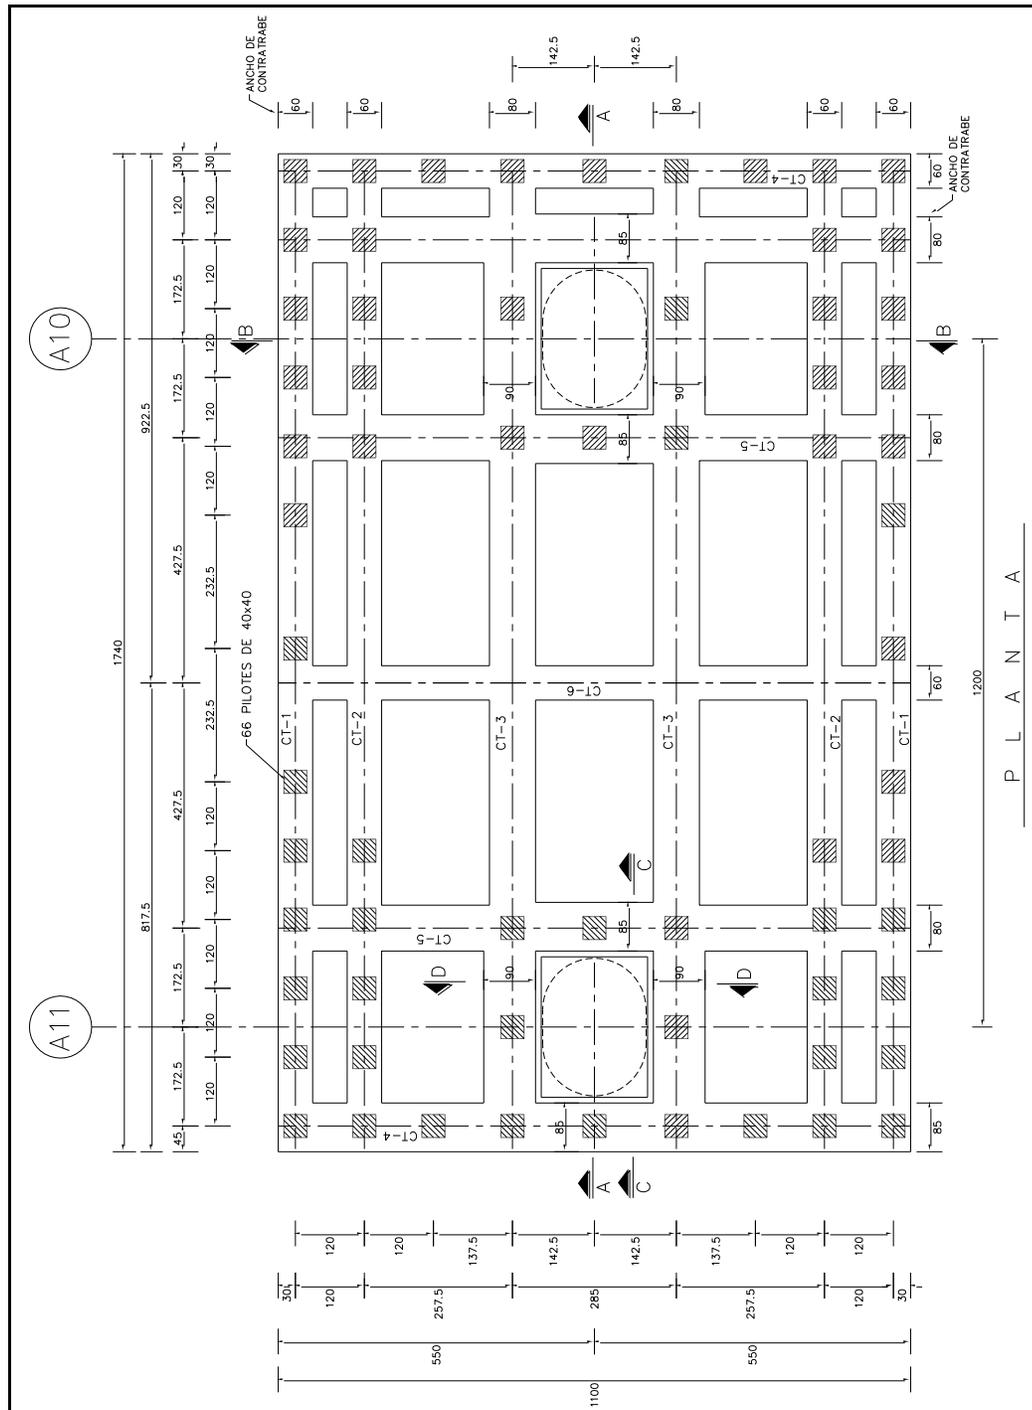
Proyección en planta de zapata, Ejes de columna A10 – A11. Todas las acotaciones están en cm, excepto donde se indique otra unidad.
